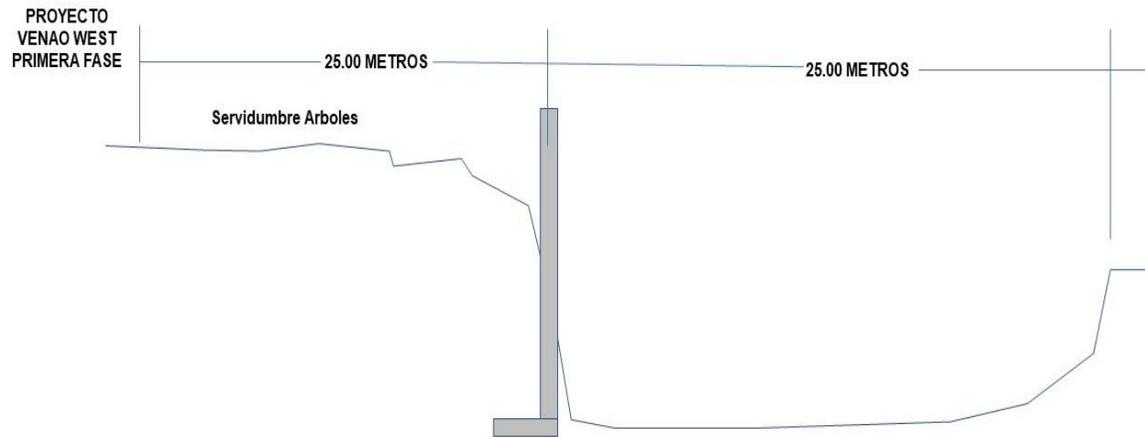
Concepto de Retiro Según los planos Mostrados
